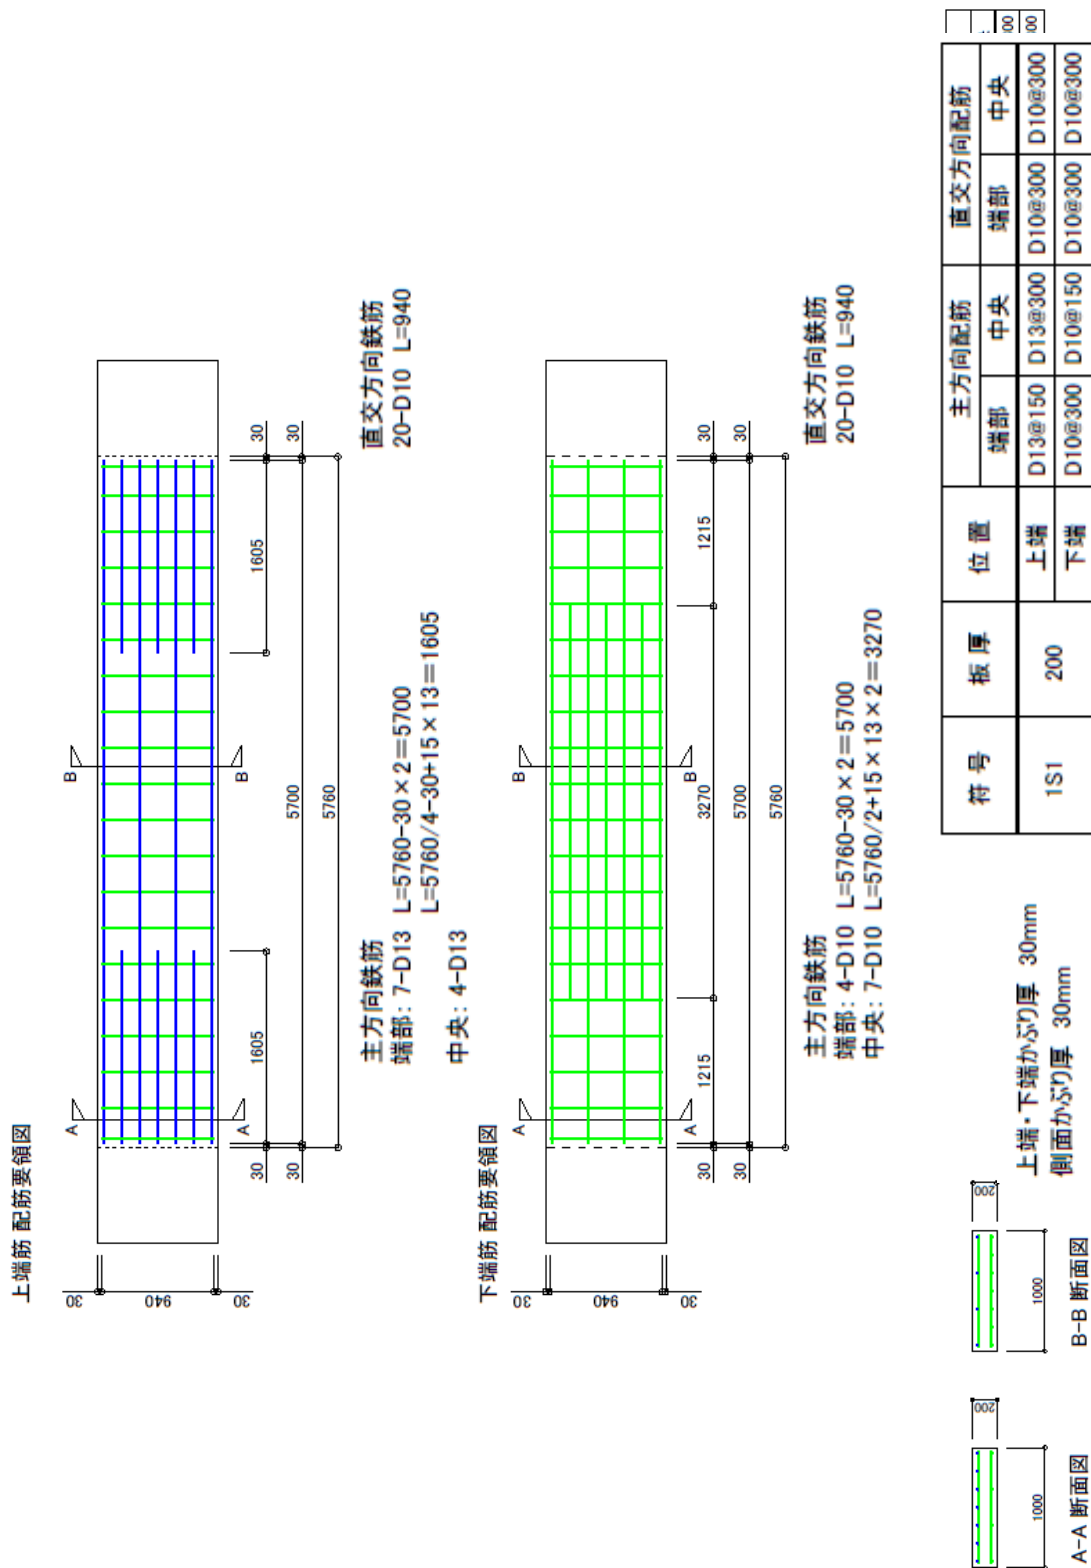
スラブ配筋図(AH, BA, AC 試験体)
